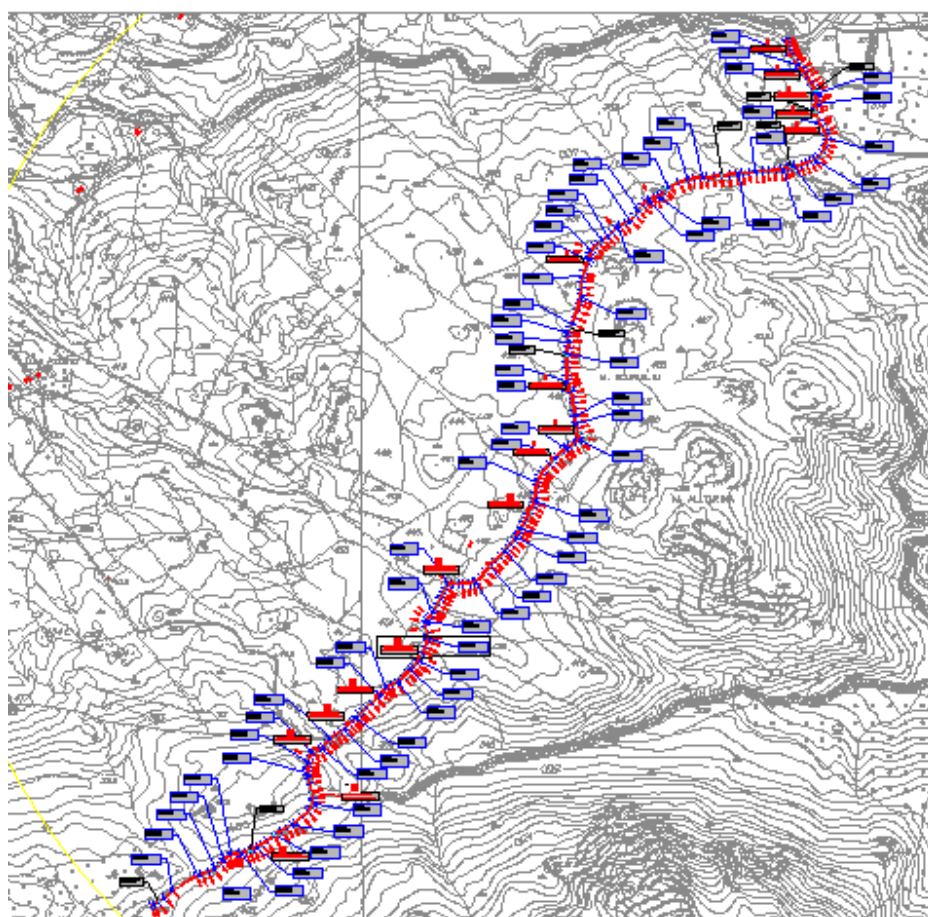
Comune di Sant'Antonio di Gallura – Strada San Santino-Vaccileddi - Estratto planimetria di intervento
